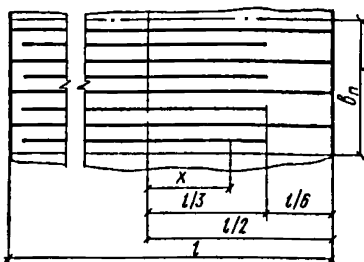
Раскладка рабочей арматуры в армированной подготовке
